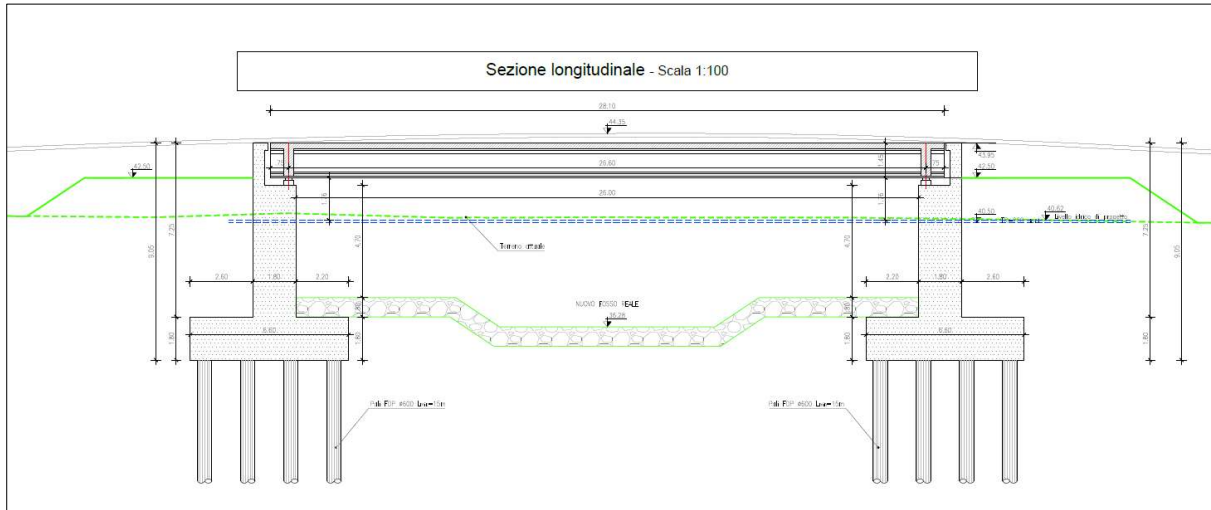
Sezione longitudinale Ponte sul Fosso Reale
